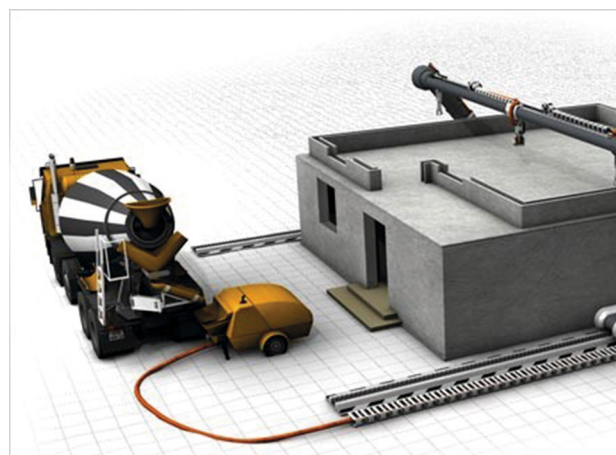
Primera aplicación de la tecnología de impresión 3D en la construcción.
